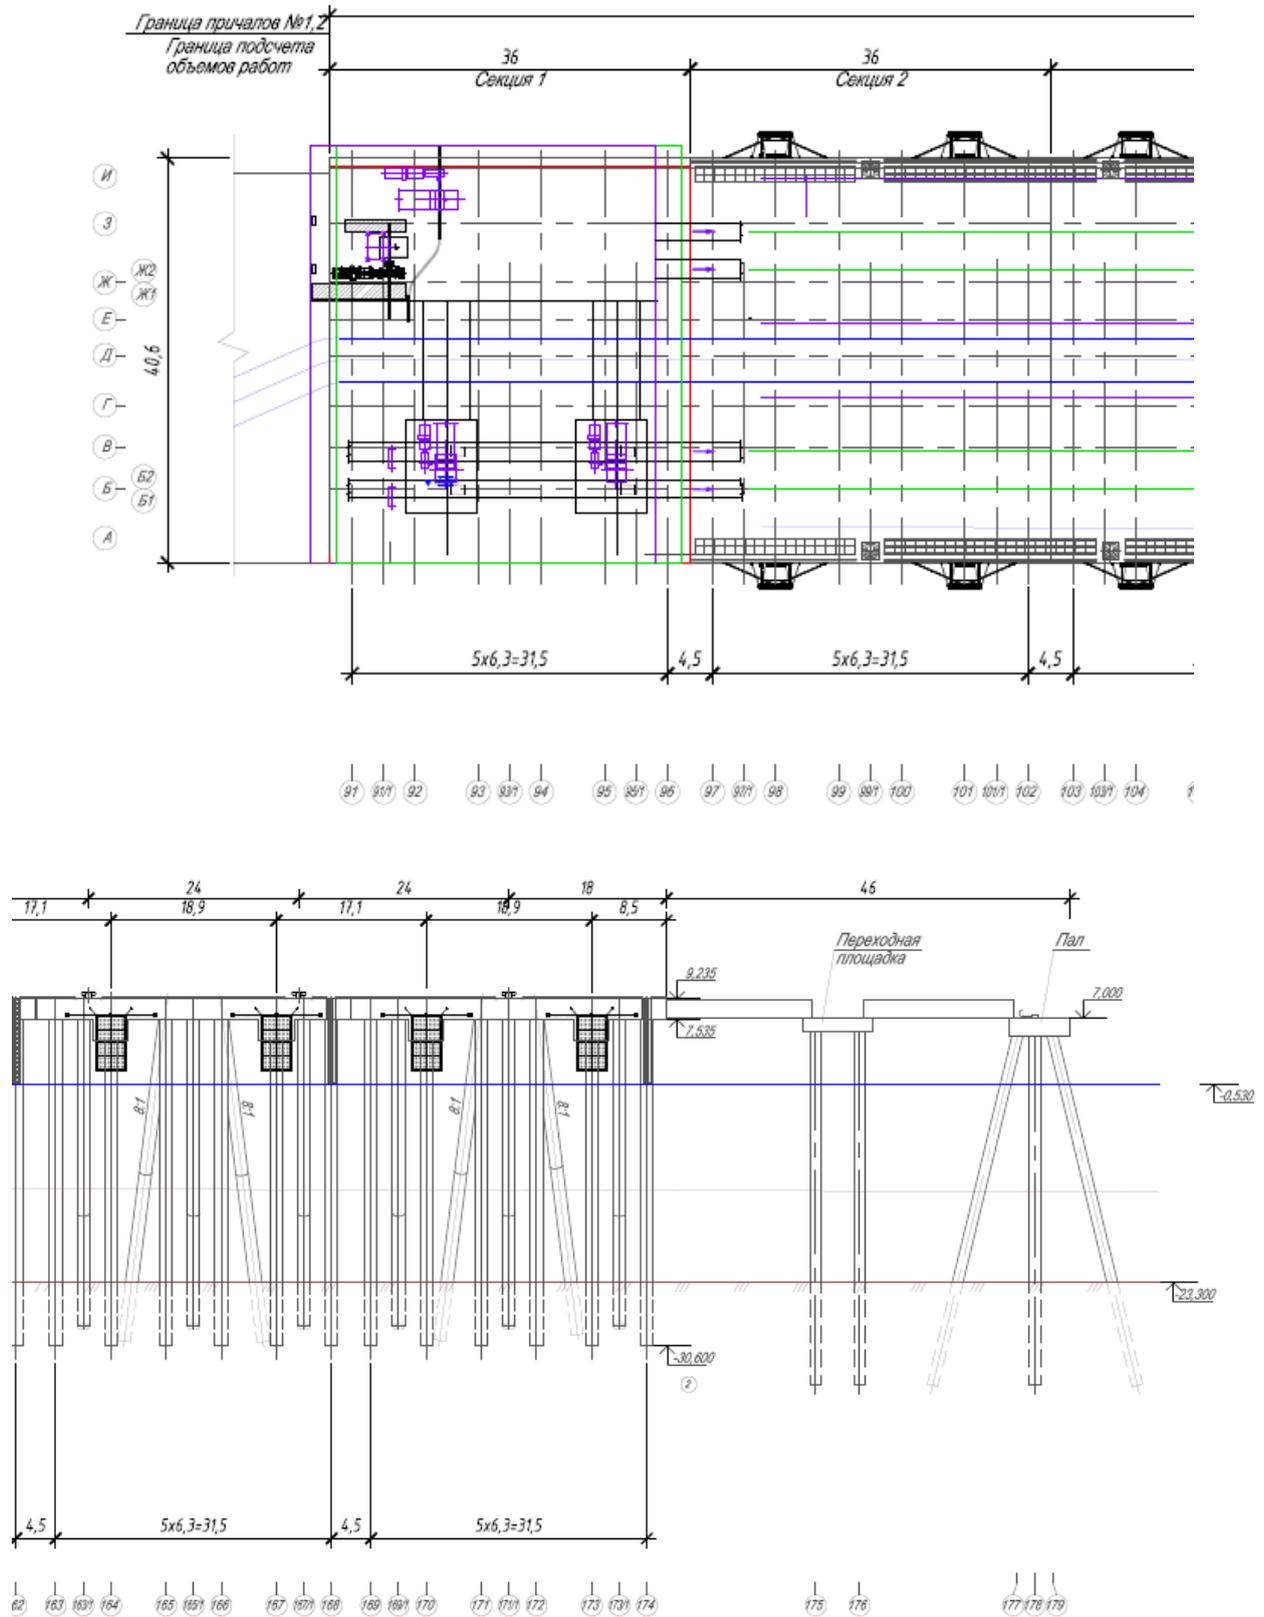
Фрагмент плана и фасада 1, 2 причалов
